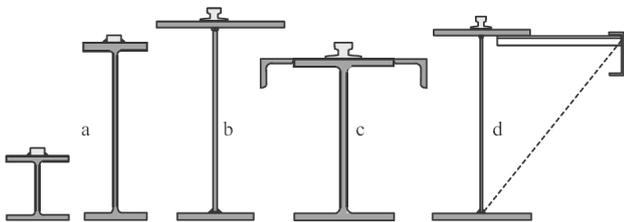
Querschnittstypen für Kranbahnträger: (a) Walzprofile, (b) I-Schweißprofile, (c) zusammengesetzte Profile, (d) Träger mit Horizontalverband
